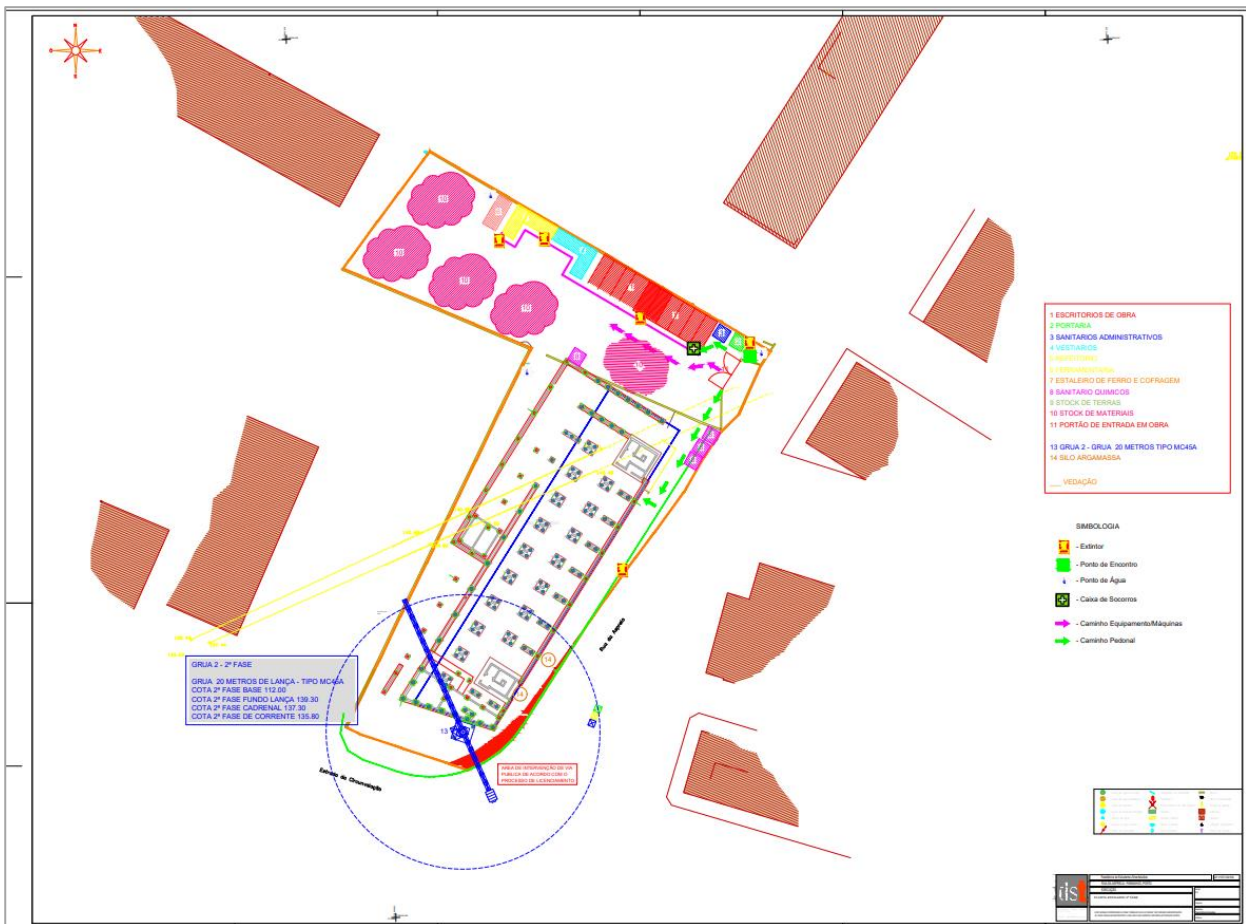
Planta de estaleiro (DST, S.A., 2022)
